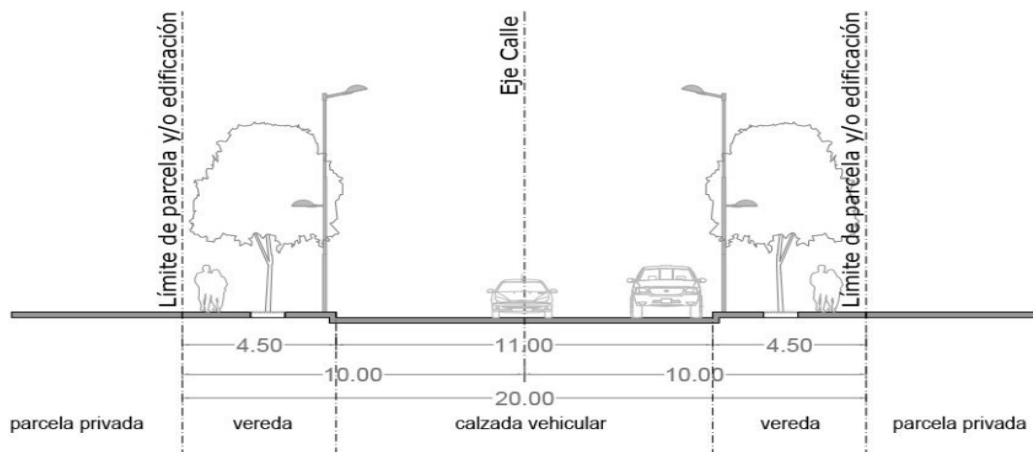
Sección transversal de Vías Calles Tipo 7.
